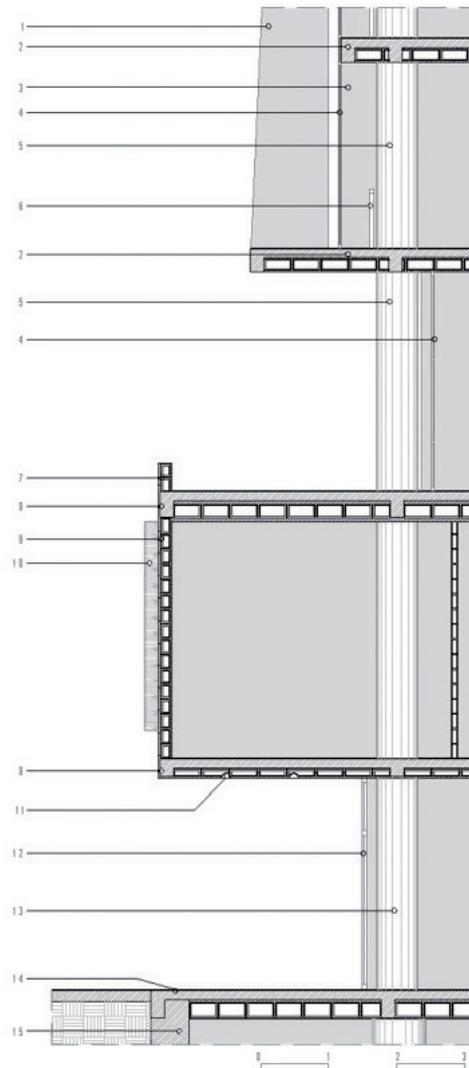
Sección constructiva de la fachada sobre la calle Venezuela.
